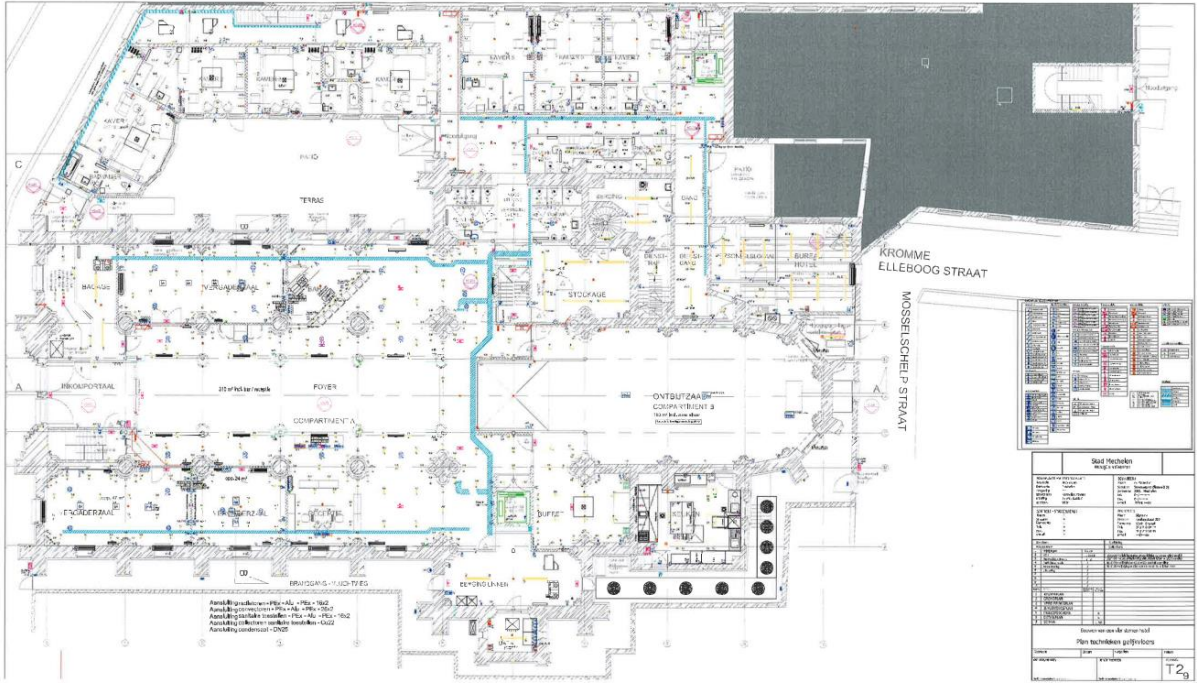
© Plan rez-de-chaussée, Martin's Partershof, Malines, Projekbureau Signa NV, [Document graphique]
